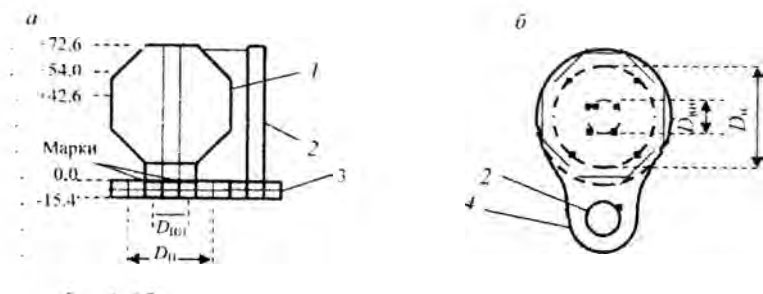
Общая схема высотного здания и мест установки осадочных марок на отметке 0.0 по контрольным окружностям:
